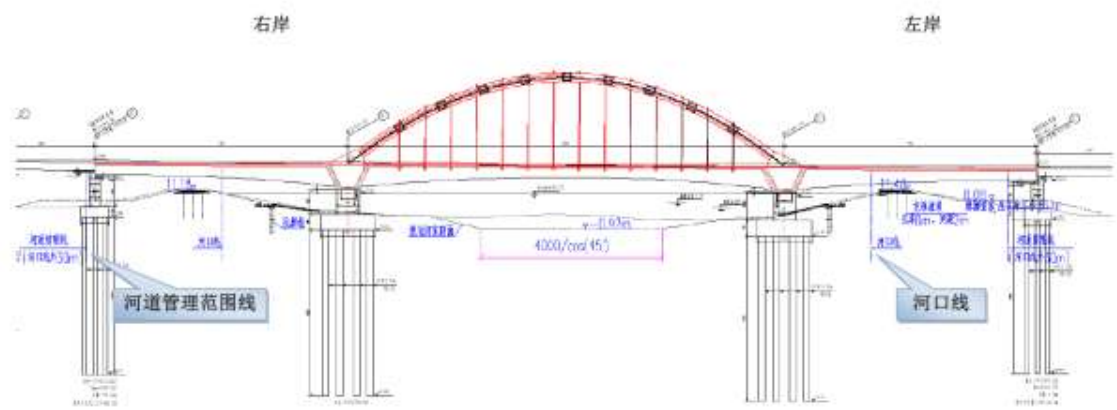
秦淮河特大桥跨河处立面布置图
